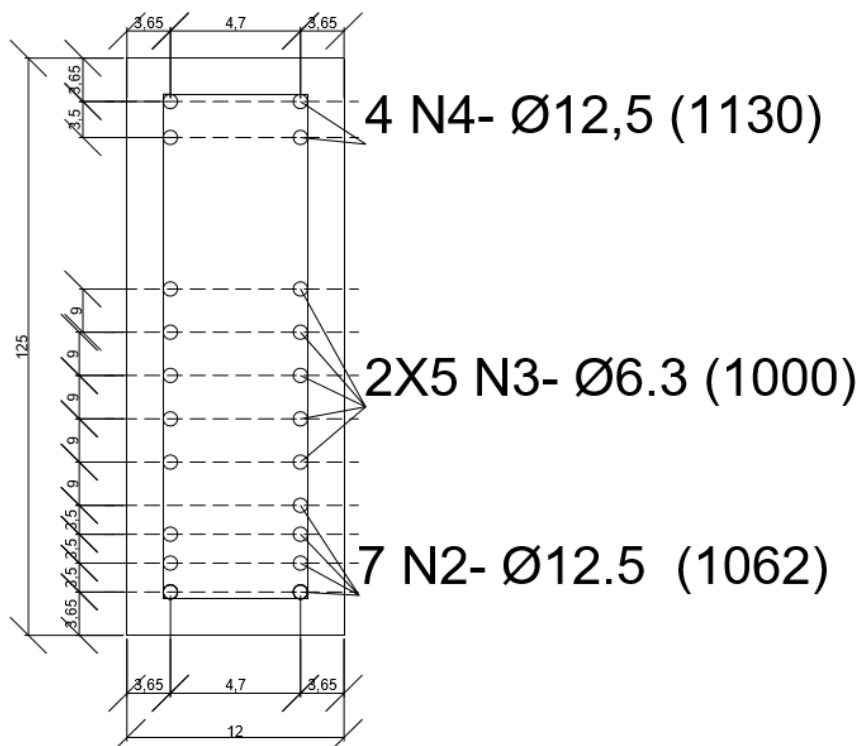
Seção transversal da viga dimensionada em concreto armado (corte AA'); medidas em cm; figura sem escala
